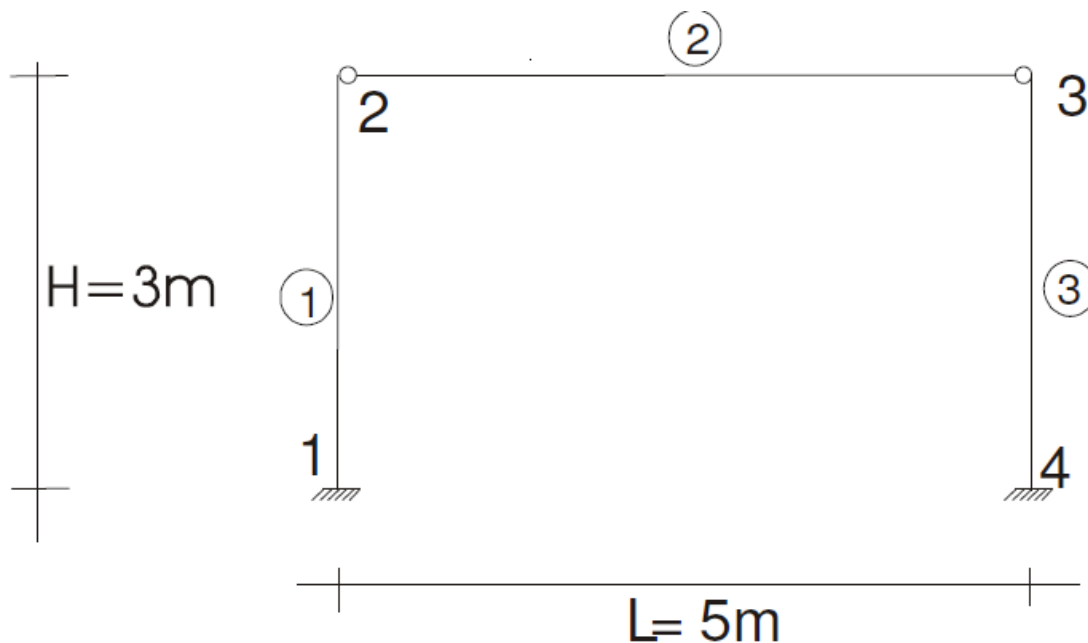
Malha de Elementos Finitos do modelo 2 (simula ligações rotuladas) composto por elementos BEAM4 e BEAM44.
